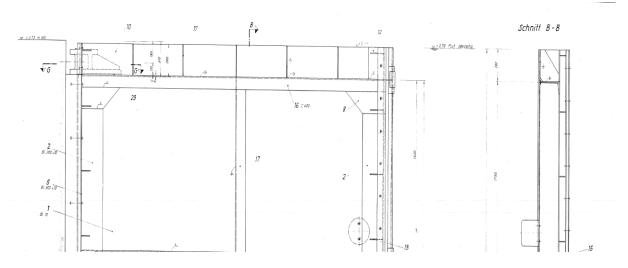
Planausschnitt Bestandsunterlagen Mühlendammschleuse, WSA Stralsund
